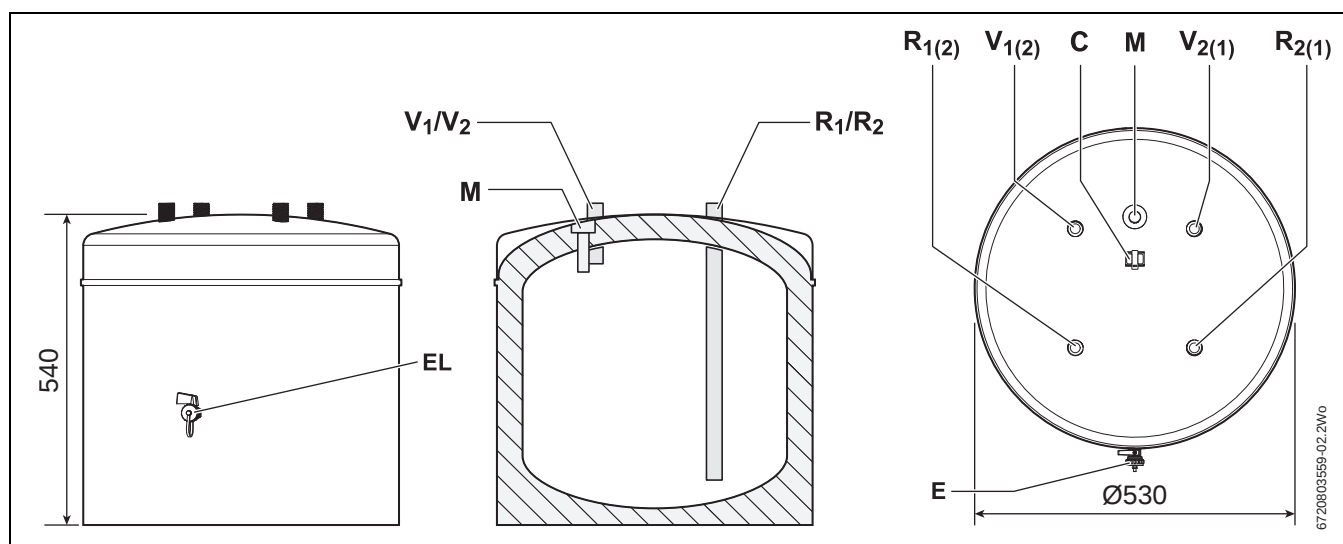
Anschlüsse und Abmessungen Pufferspeicher PSWK 50 (Abmessungen in mm)
